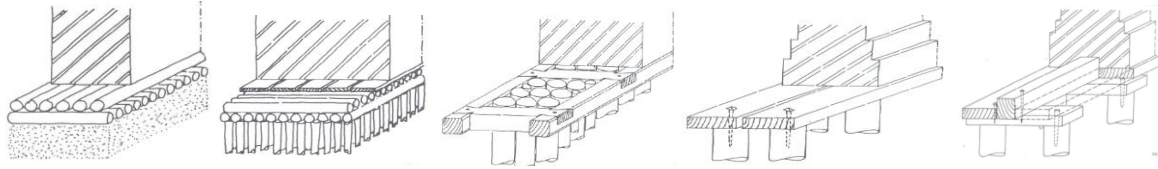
Ahşap Izgara, (Notes on Building Cons., s.228) (Baker, 1902) (Ashpitel, 1867)
